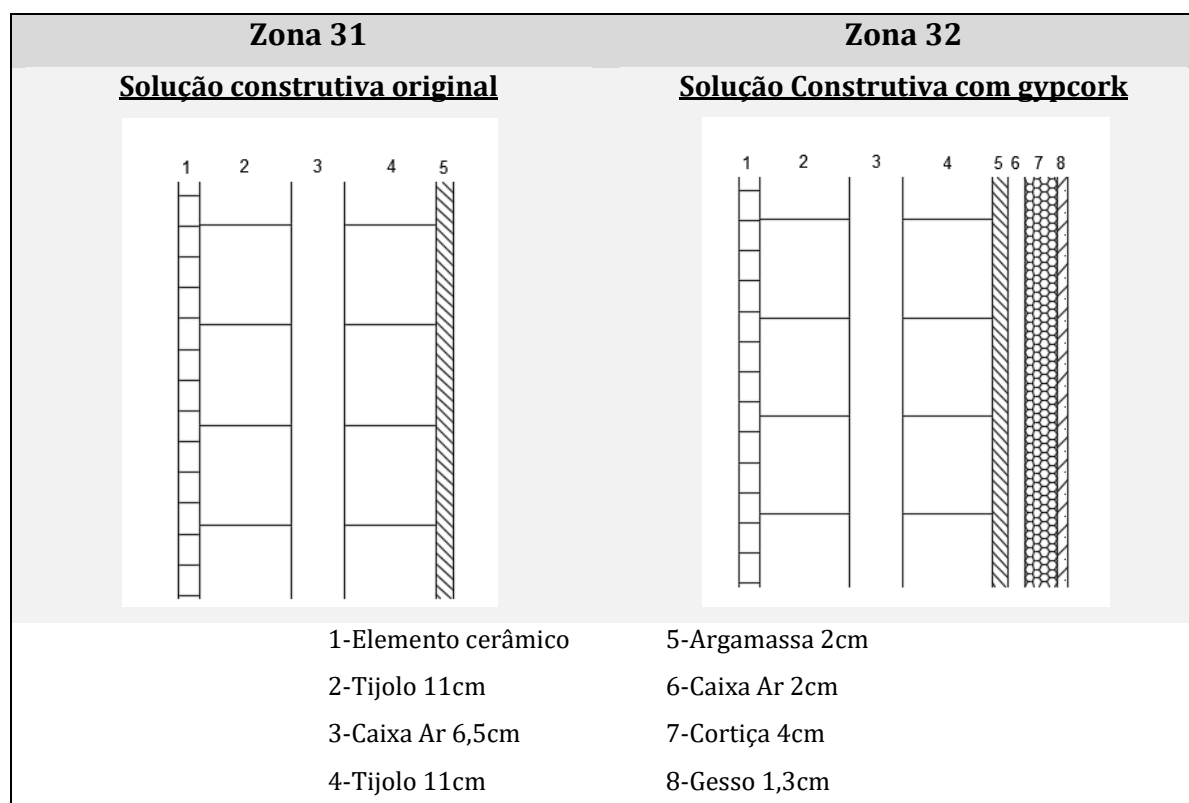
Solução construtiva das zonas 31 e 32, na fachada sul.
